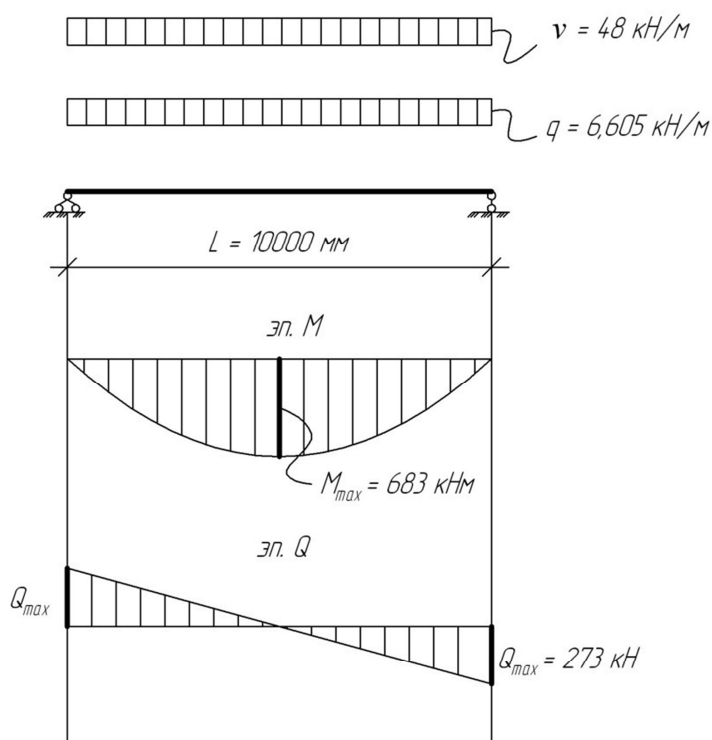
Расчетная схема главной балки. Определение усилий
